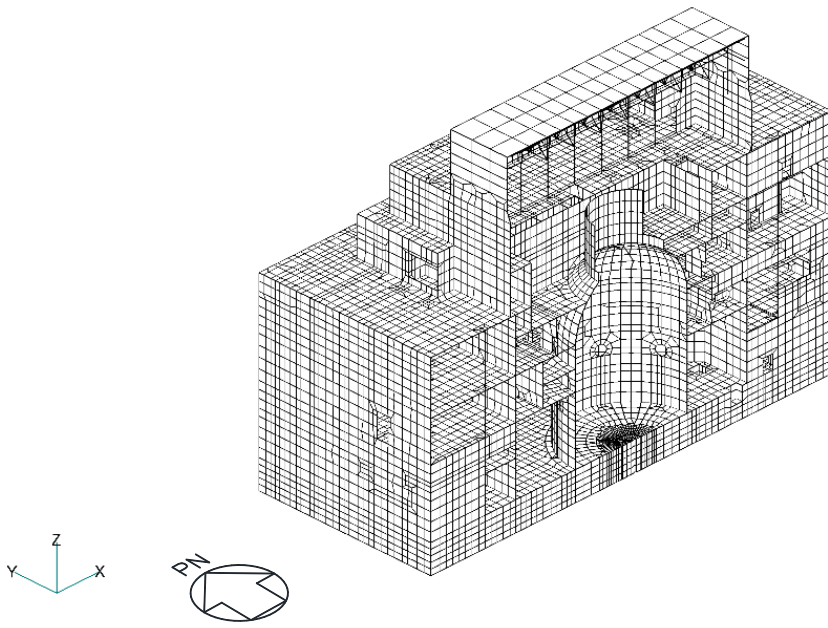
原子炉建物の 3 次元 F E Mモデルの概要図 (断面図)
